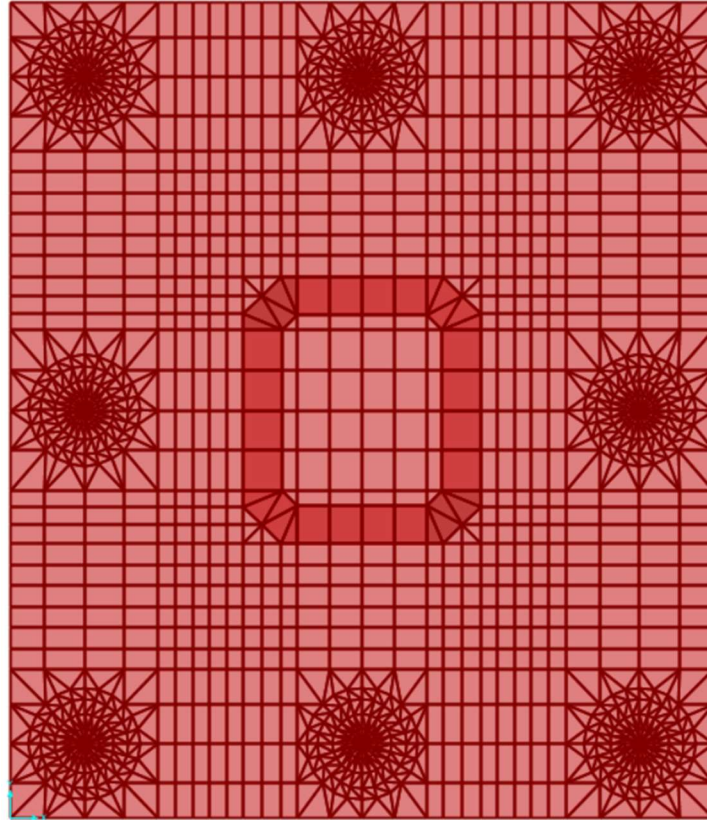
Vista de planta de la base inferior de la columna, donde se aprecia la zapata y las pilas
